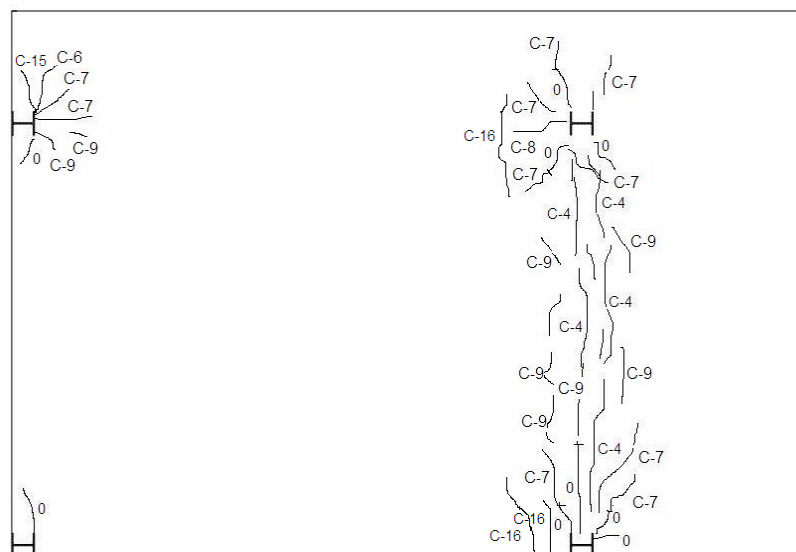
Esquema do surgimento de fissuras - 8ª etapa de carregamento concentrado
